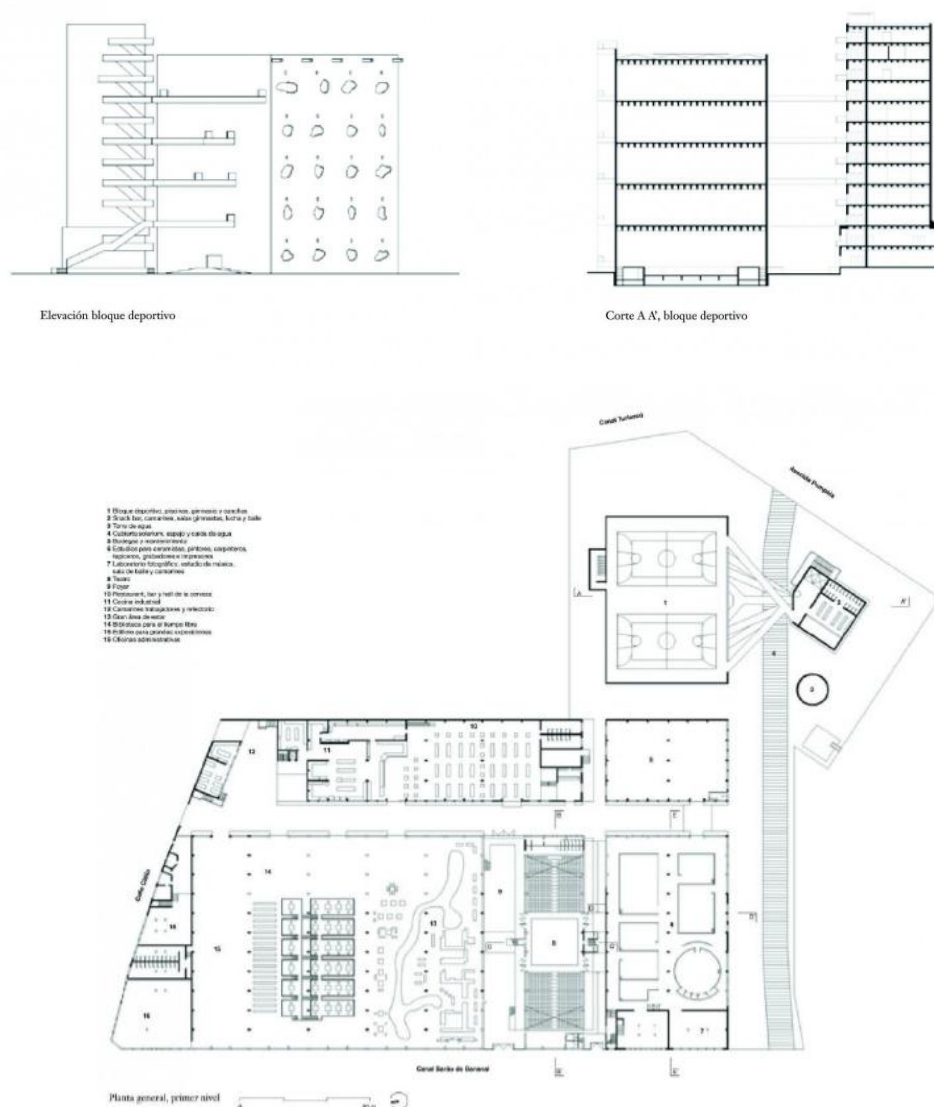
Elevação/Corte. Planta do Centro de Lazer.
